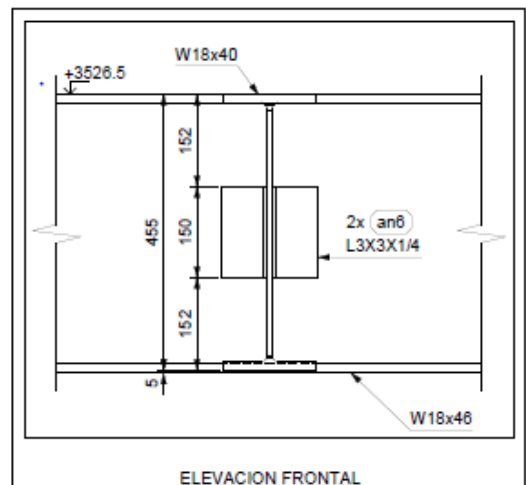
37. Vista frontal de conexión de vigas de entrepiso. Fuente: Planos de taller en Advanced Steel de Grupo Yeril S.A.
